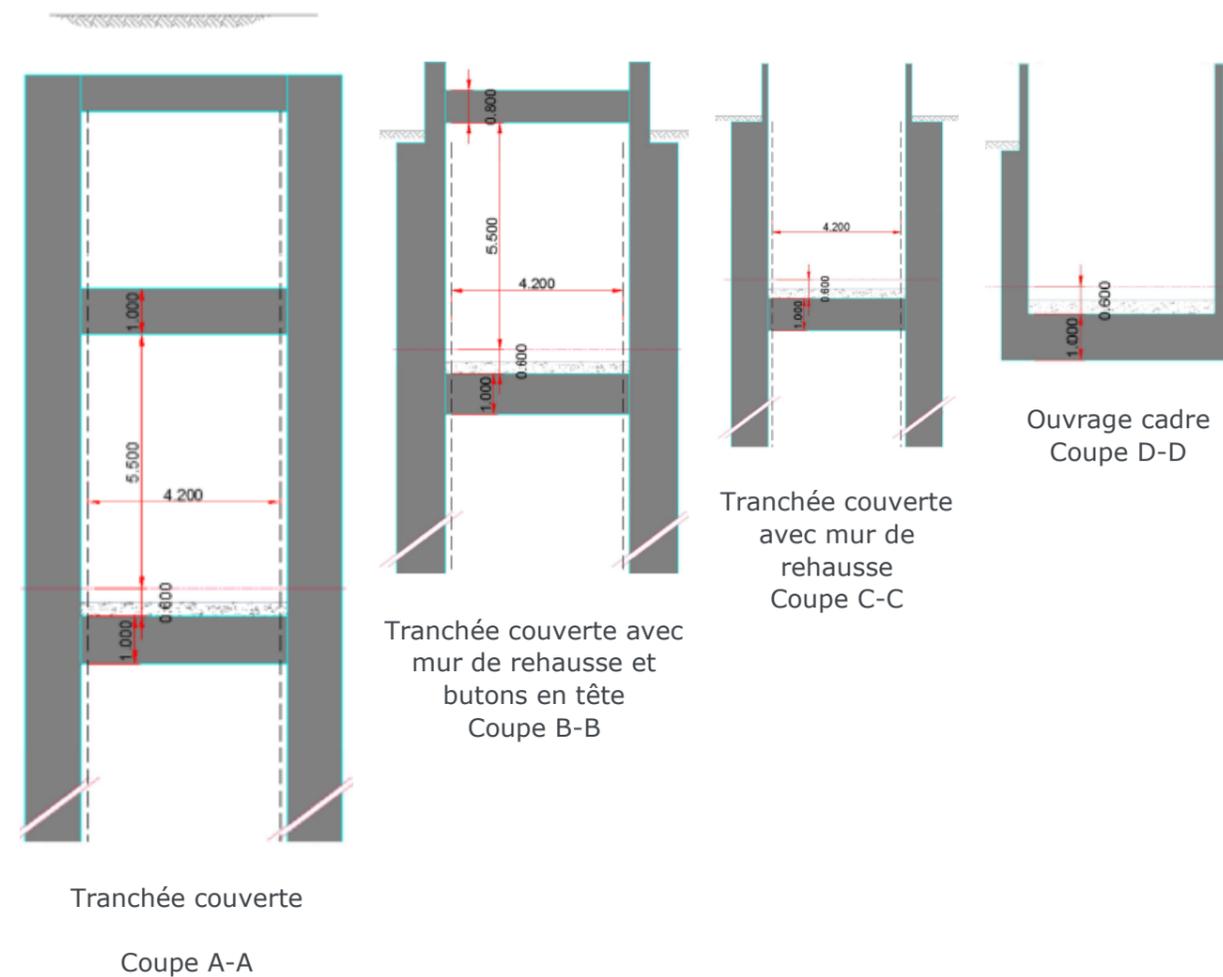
Coupe transversale de la tranchée ouverte (à droite) et couverte (à gauche)
